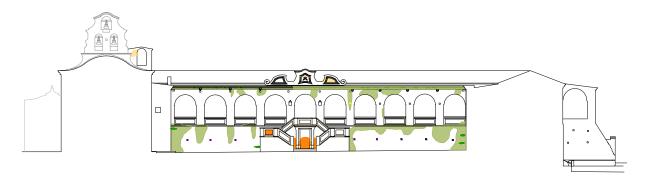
Relevamiento de lesiones - Fachada interna Este - Primer Patio
